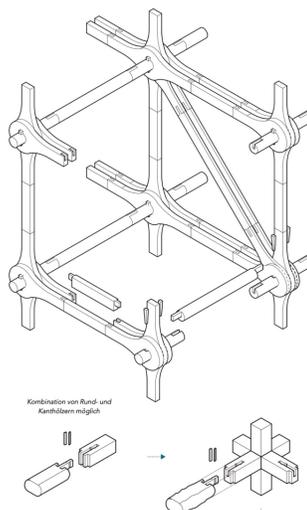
Astgabel als Knotenpunkt, Annäherung statisches System u. Längsverbindung Anschlussbalken
